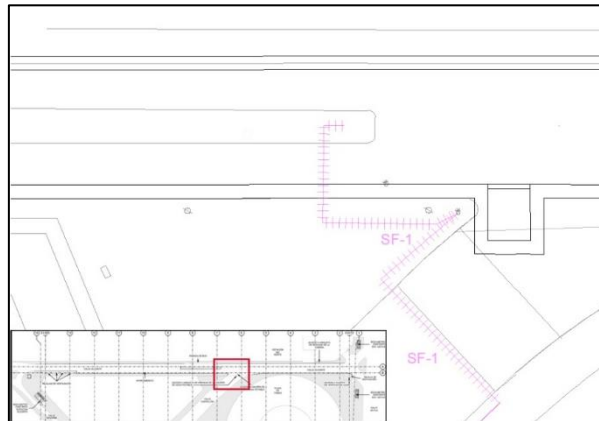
Plano de servicio afectado SEMF-SF1-SA-CX-F4
